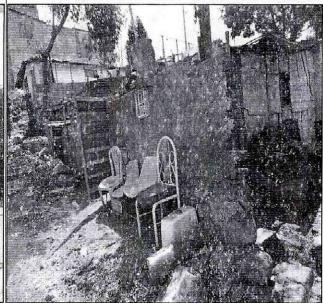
Vista de la vivienda emplazada en el predio de la Avenida Carrera 12 Este No. 37-54 Sur, Barrio Nueva España de la Localidad de San Cristóbal.
